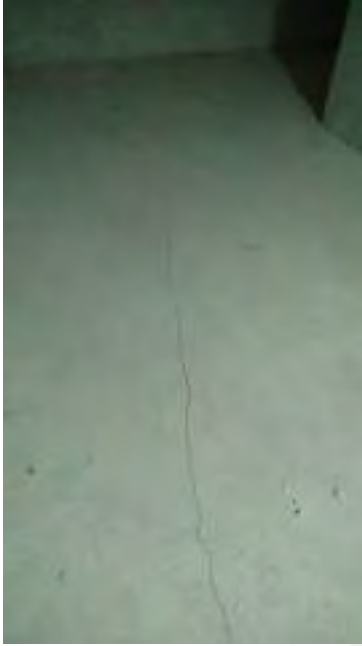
Grupo de Fisuras G8 (2)
